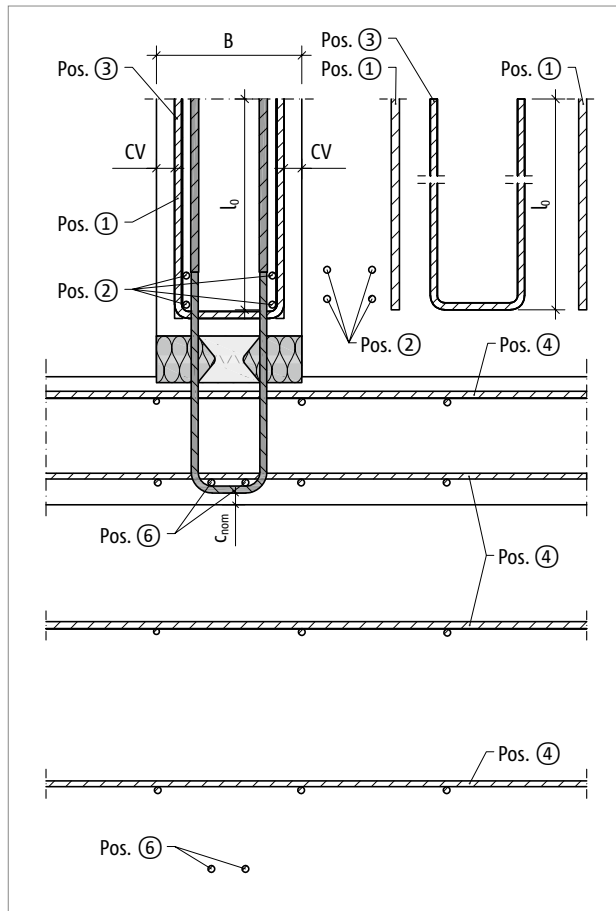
Schöck Sconnex® type W-NT-B : renforcement sur site dans le cas d'un ancrage de l'effort de traction dans la dalle
